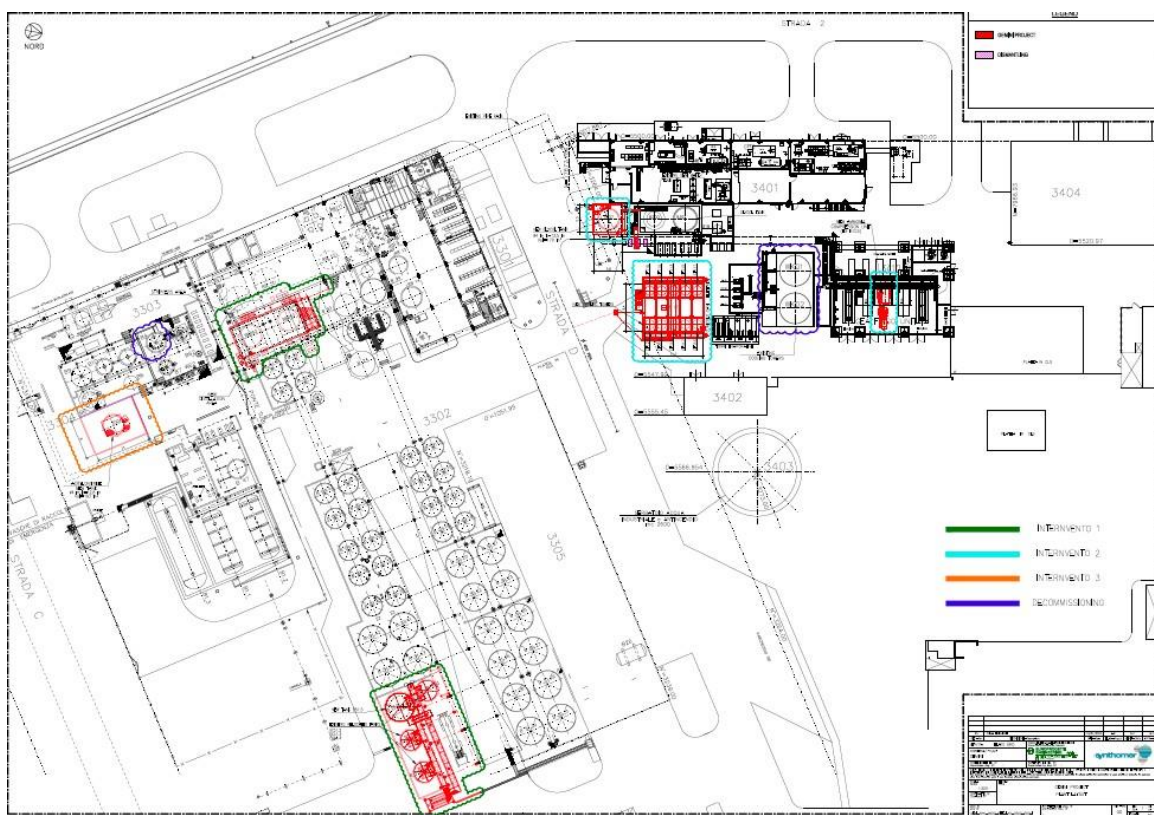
Allegato C.13.3 planimetria aree oggetto di modifiche
